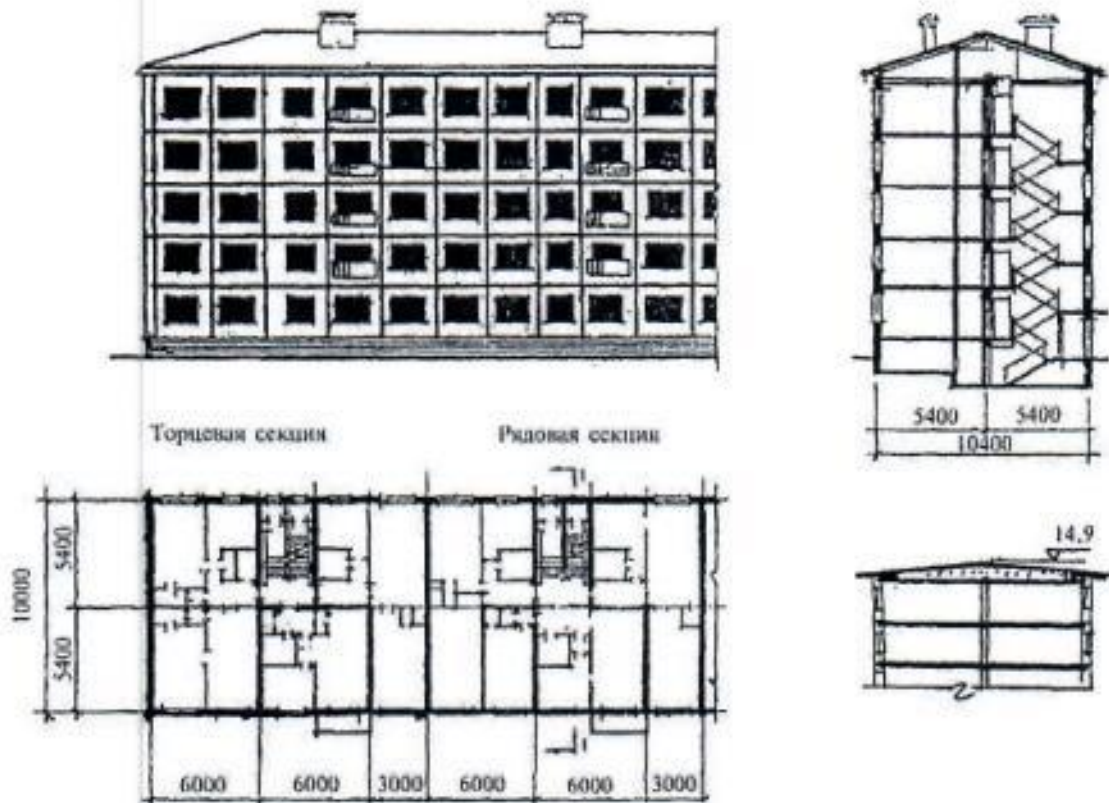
Фасад, план типового этажа и разрез крупнопанельного жилого дома серии 1-468
